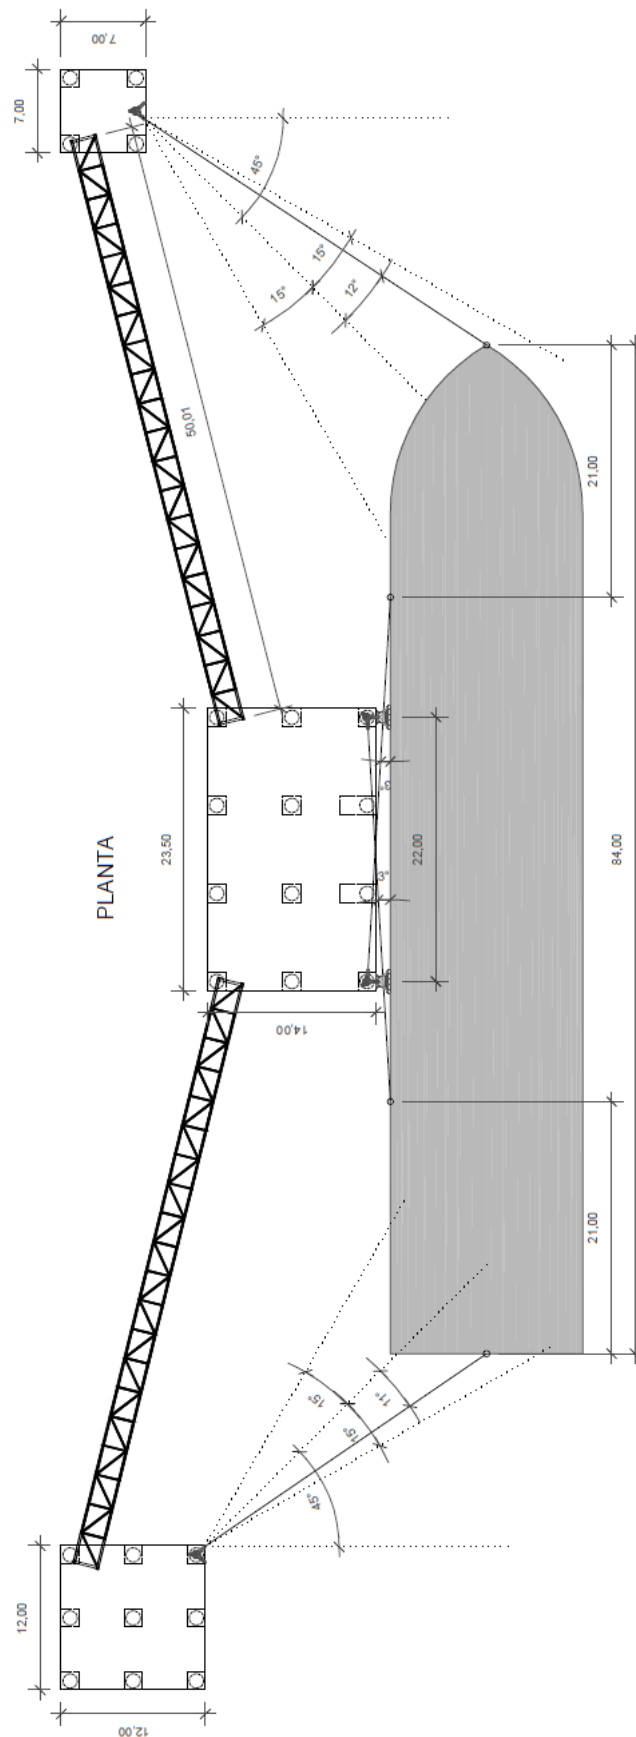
Encaje geométrico en planta del atraque de proyecto.
